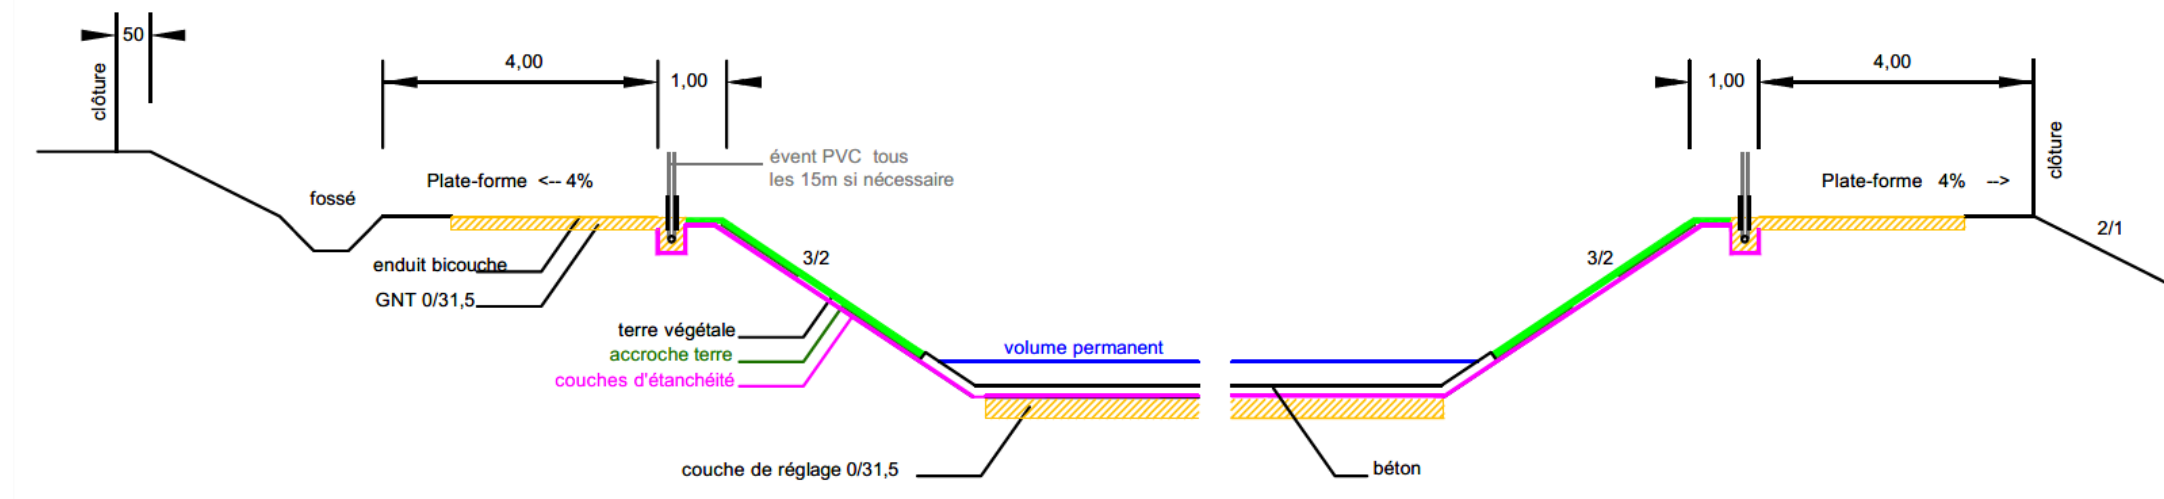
Plan et coupe types de bassins routiers (source : DIRE)
